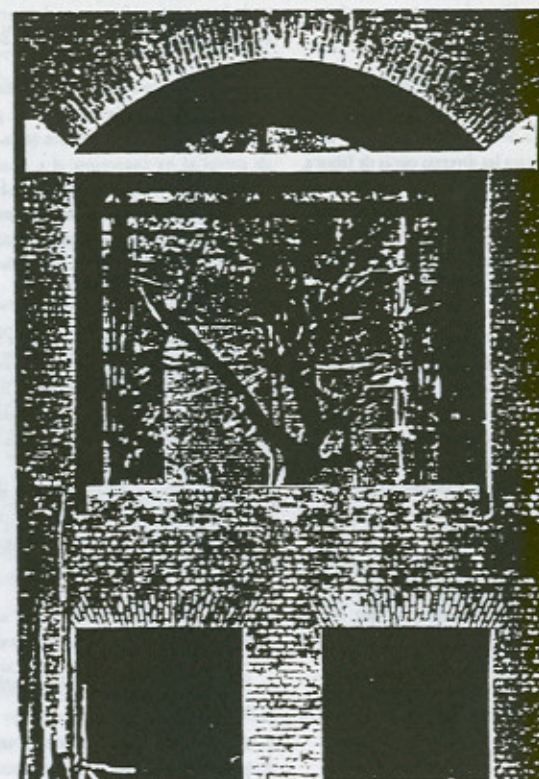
Arco rebajado de fábrica de ladrillo. Tirante de hormigón armado. (Louis Kahn. Instituto Hindú de Cuadros, Ahmedabad 1963).
